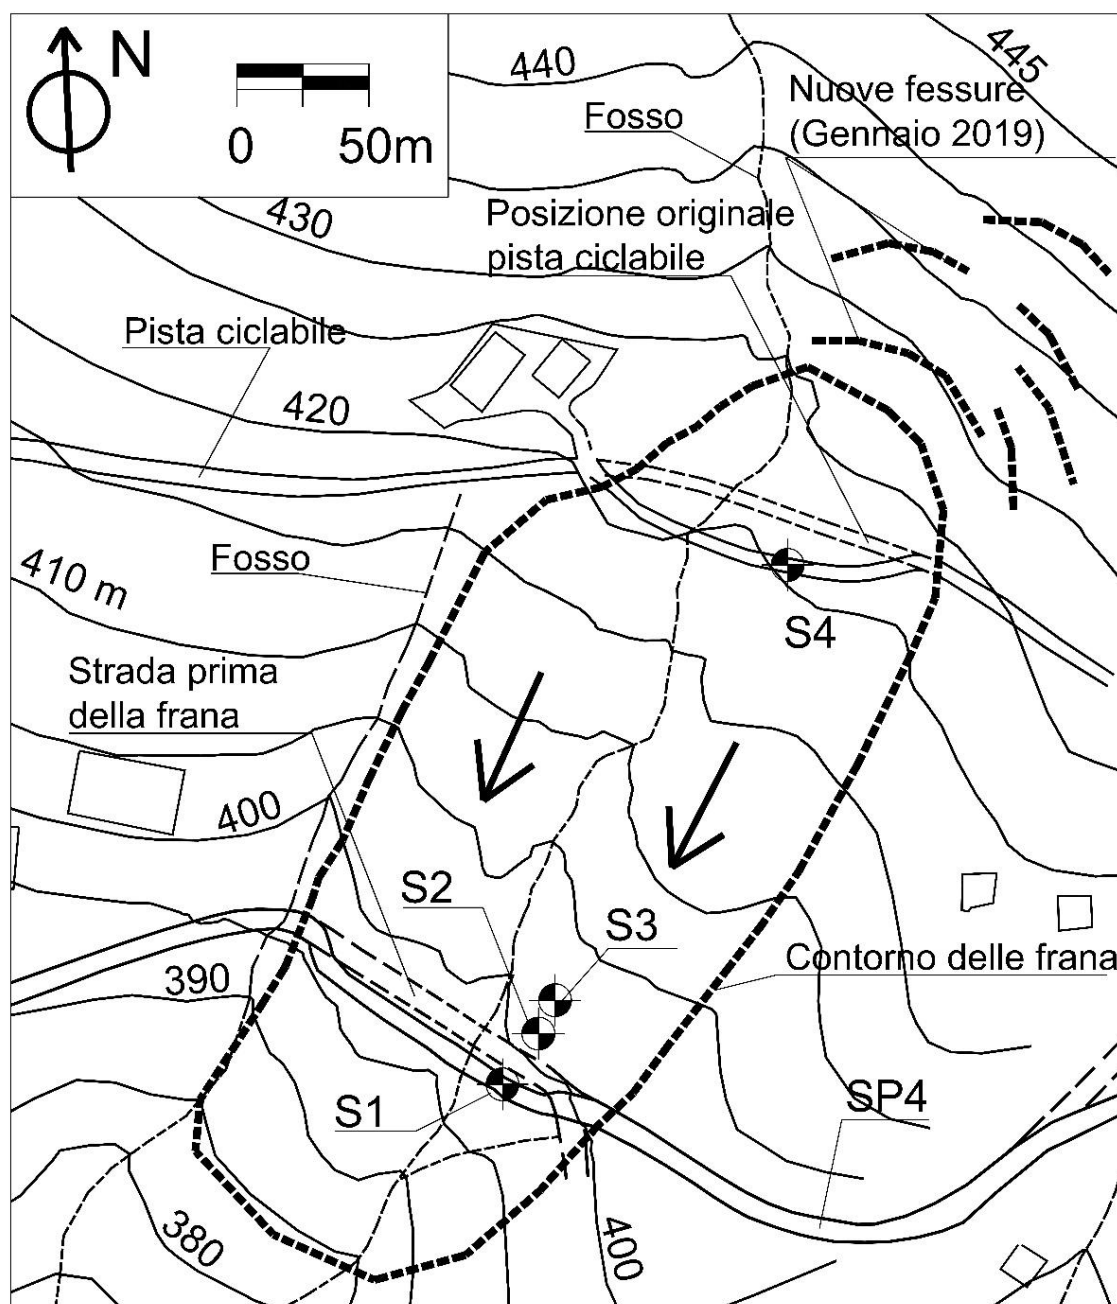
Dissesto al km 22+700. Planimetria con estensione della zona in frana.
